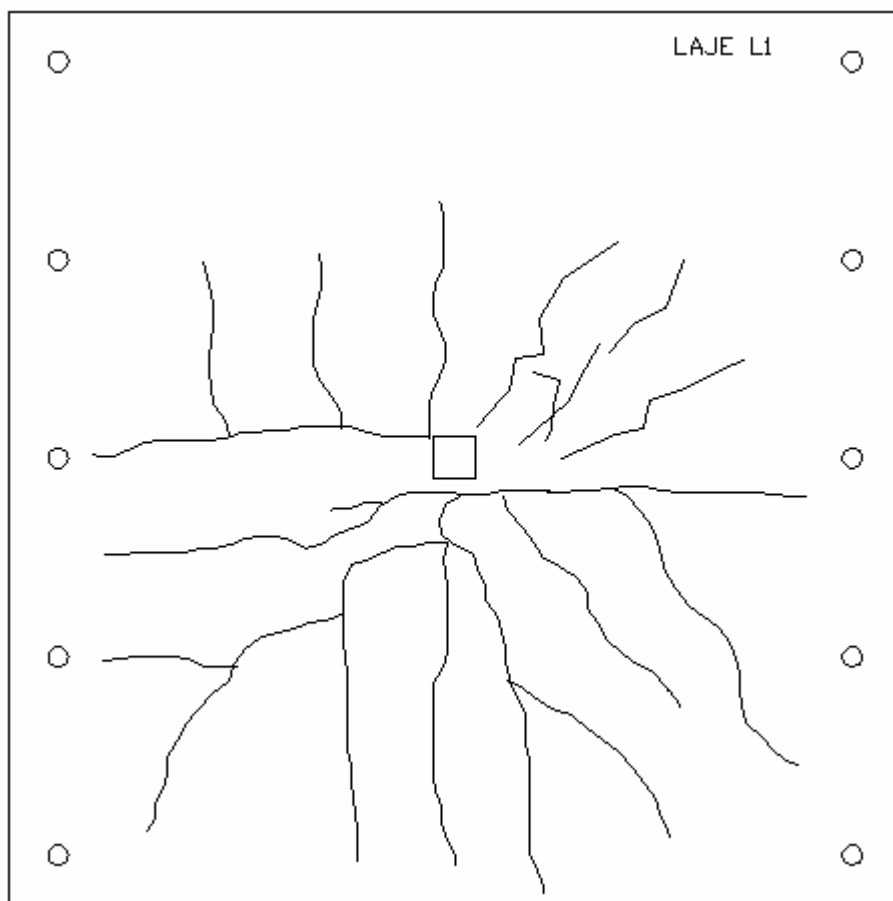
Mapa de fissuração da laje L1
